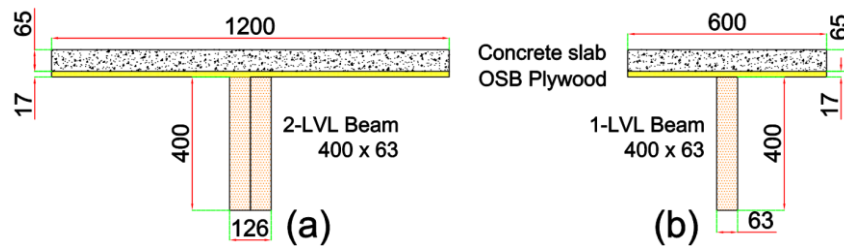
La section des poutres BBC testées : (a) F1 et G1, (b) la section réduite du reste (dimensions en mm) [4].
